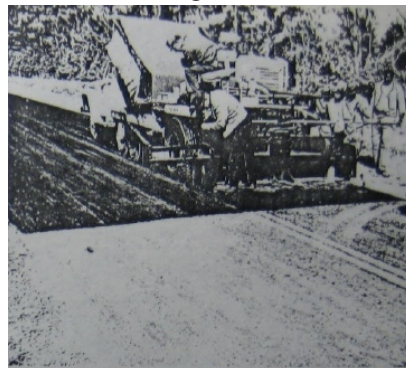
Colocando un recubrimiento delgado de material mezclado en planta en caliente
